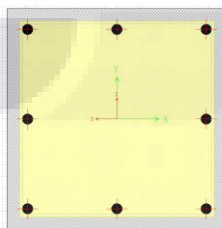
Detalle del modelado de la sección columna dentro del software SAP2000.
